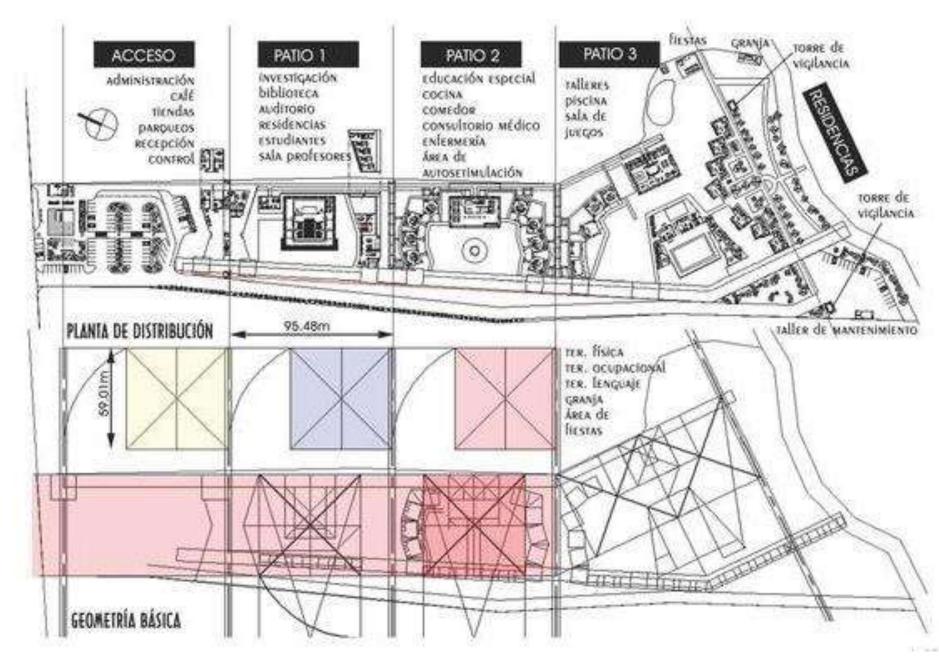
Planta de Distribución Fuente: José Lee Arquitectura
